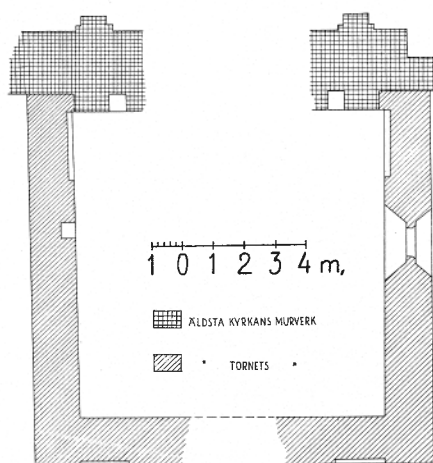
Västtornets ursprungliga plan, 1: 250. Rekonstruktion av E. Bohrn 1944.
